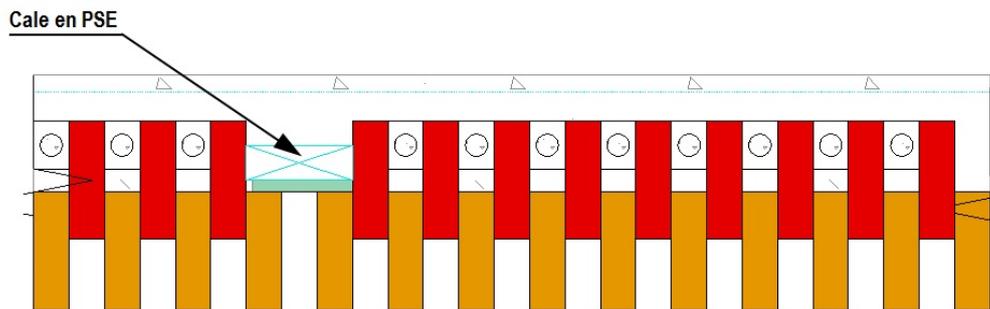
Détail de la jonction plancher/mur sur vide sanitaire
